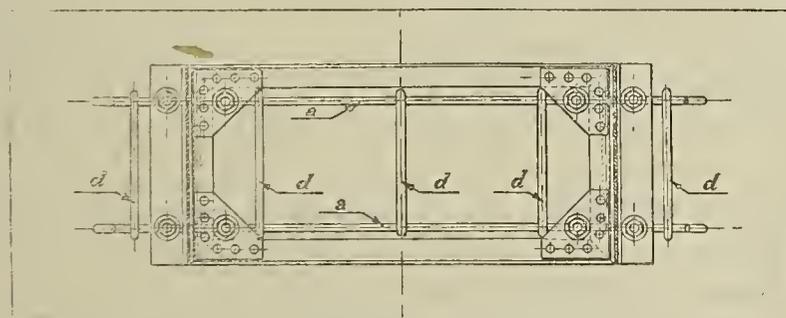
Plan de la fondation d'un poteau d'angle.
